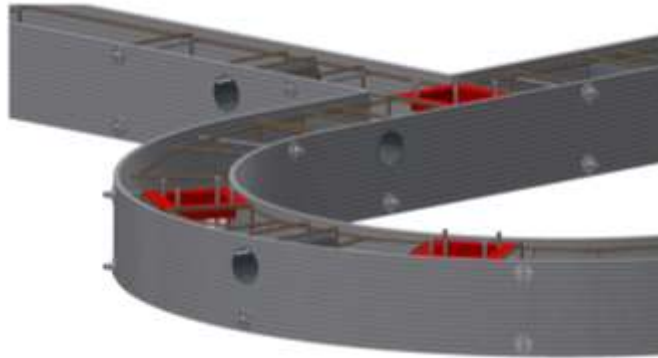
Material férreo de cimentación y conectores estructurales horizontales
